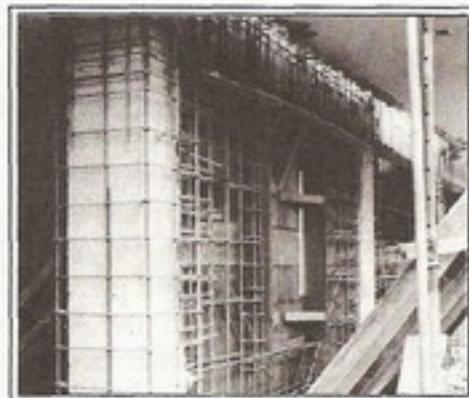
Construcción de un muro estructural acoplado al sistema de marcos para limitar los desplazamientos laterales y reducir daños no estructurales.
